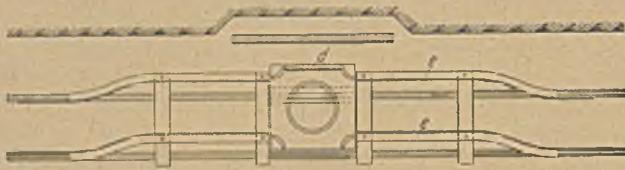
Grundriß der Ringbühnenplatte, Bauart Kisker.
